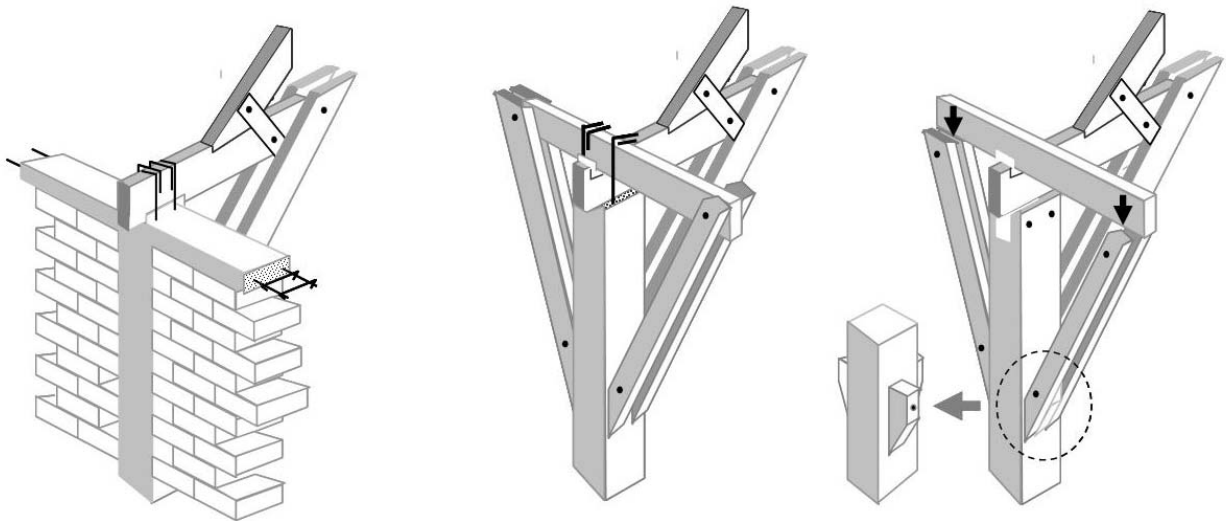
weitere Anschlussdetails für Dachkonstruktion (Posyanis (2006))
